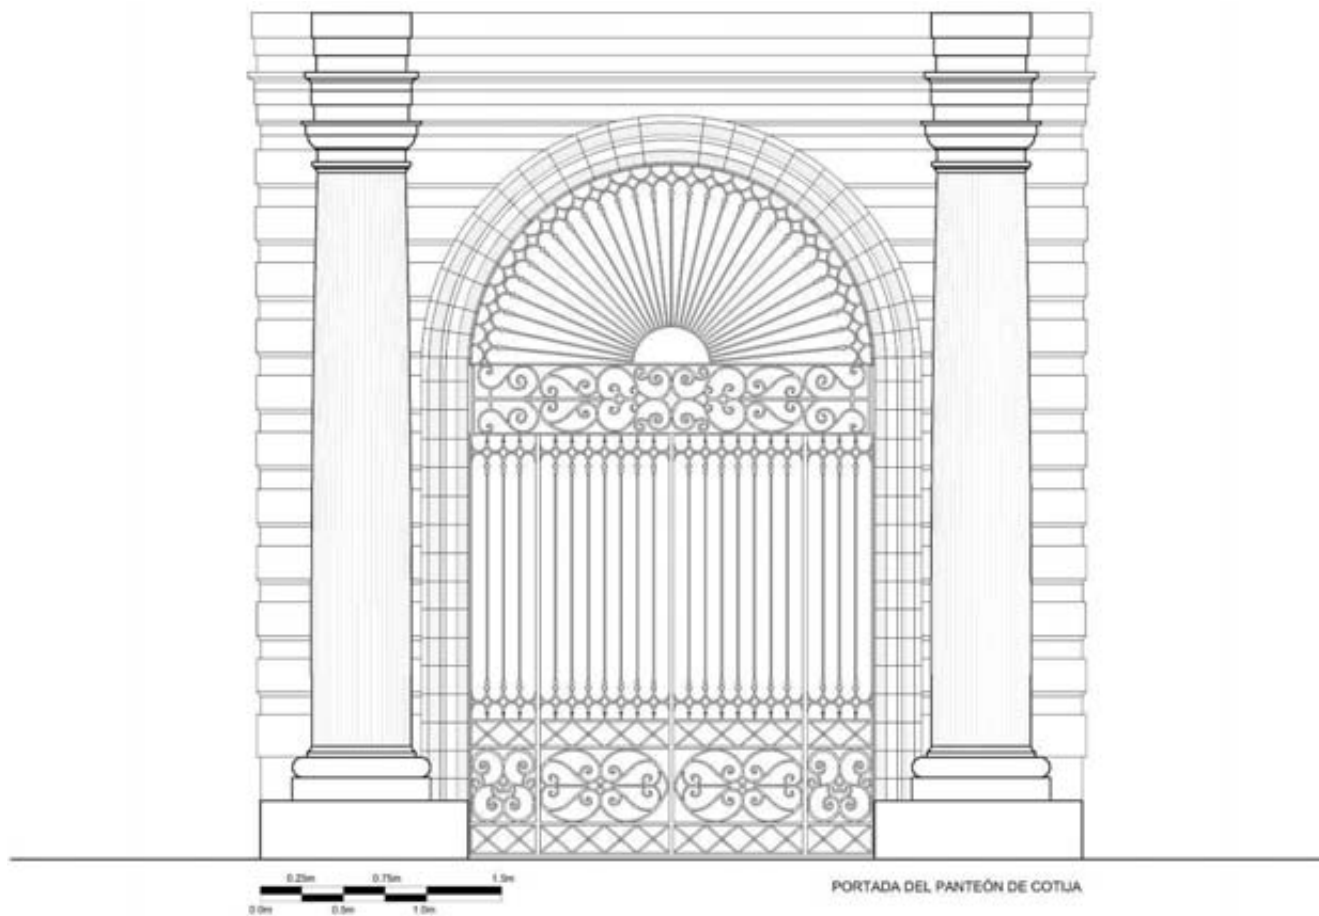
Fachada de la Portada del Cementerio de Cotija de la Paz, Michoacán.
